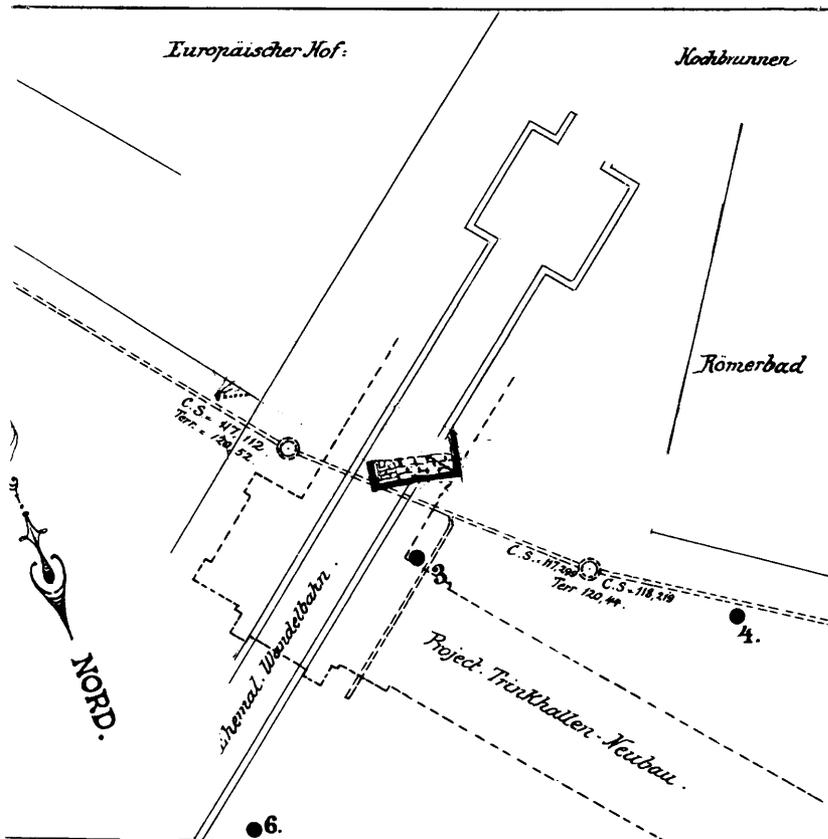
Grundrißzeichnung vom Kochbrunnenplatz um 1880 (Ausschnitt). Mitte: bei Tiefbauarbeiten angeschnittenes mittelalterliches (?) Badebecken (v. COHAUSEN 1889).
